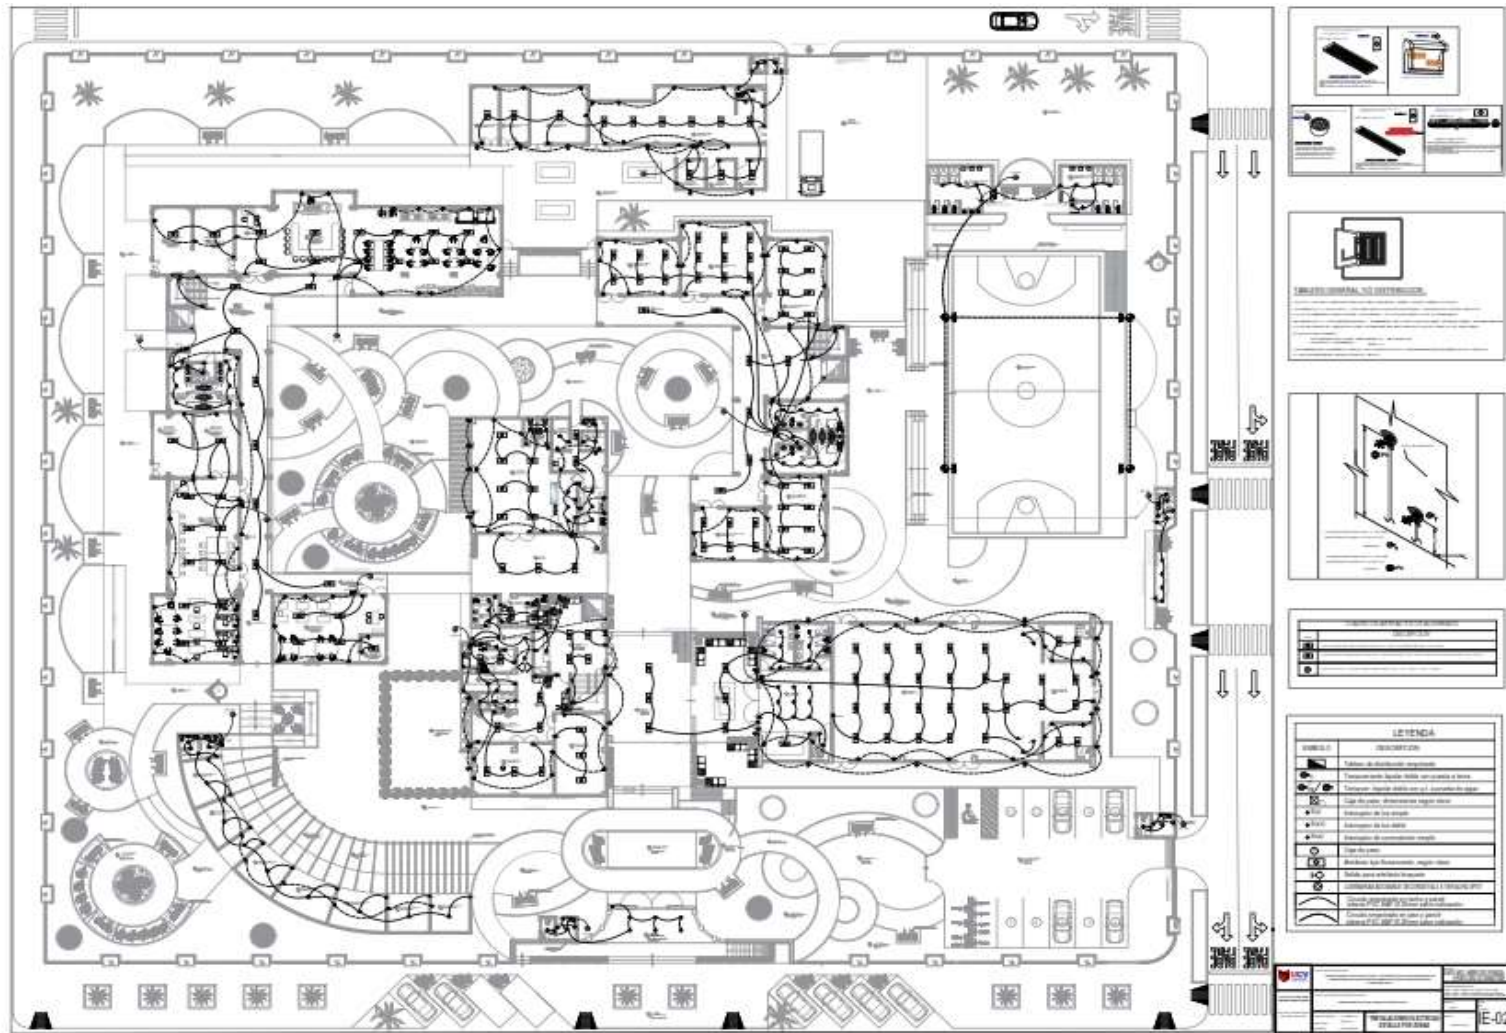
Plano de instalaciones eléctricas en detalles – Lamina IE-02
